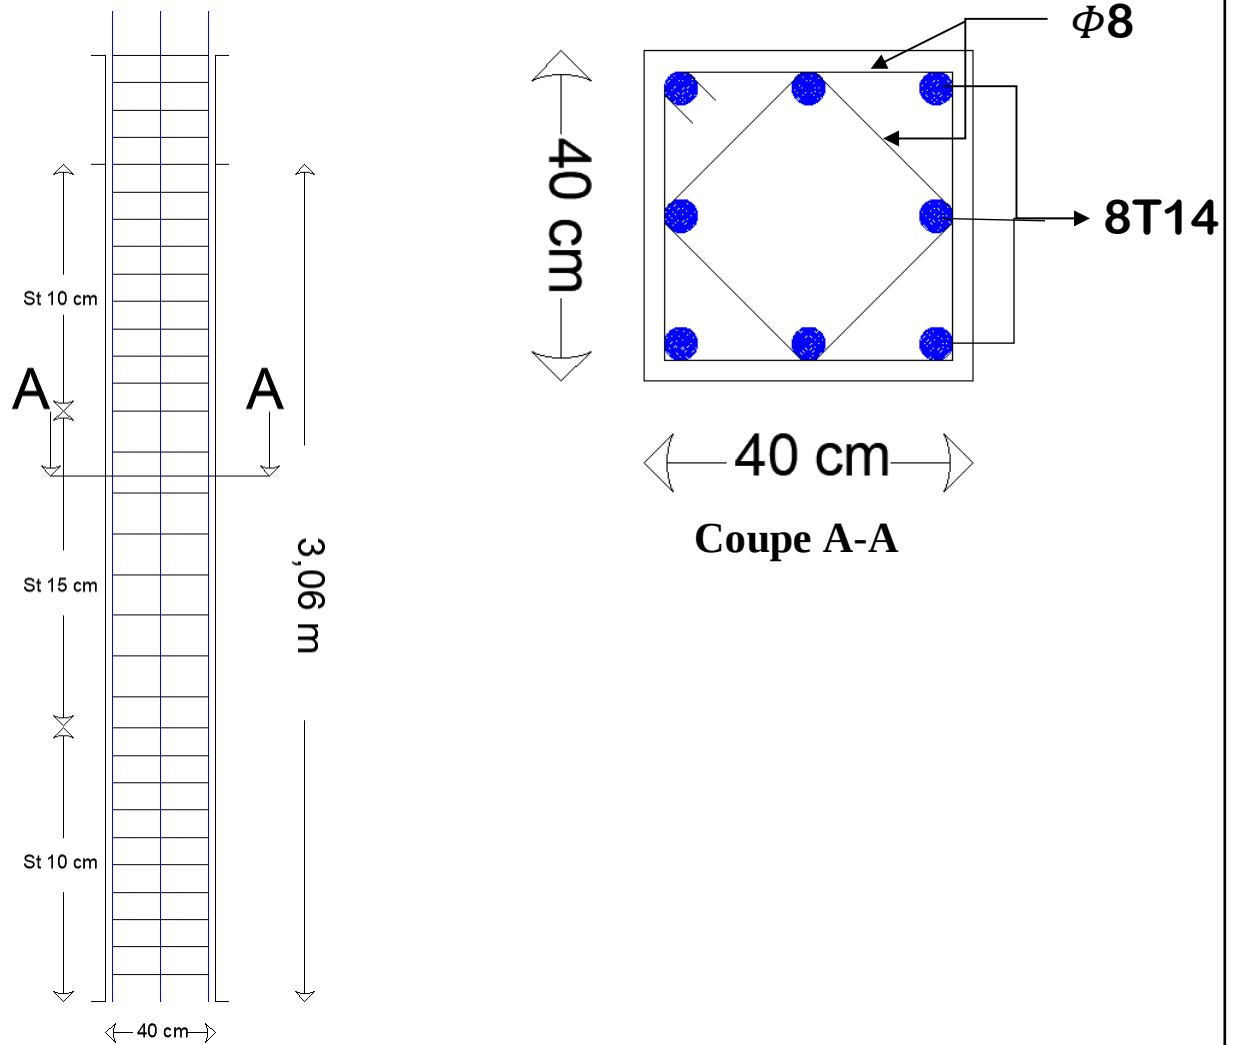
Schéma de ferrailage des poteaux (40x40) cm.
